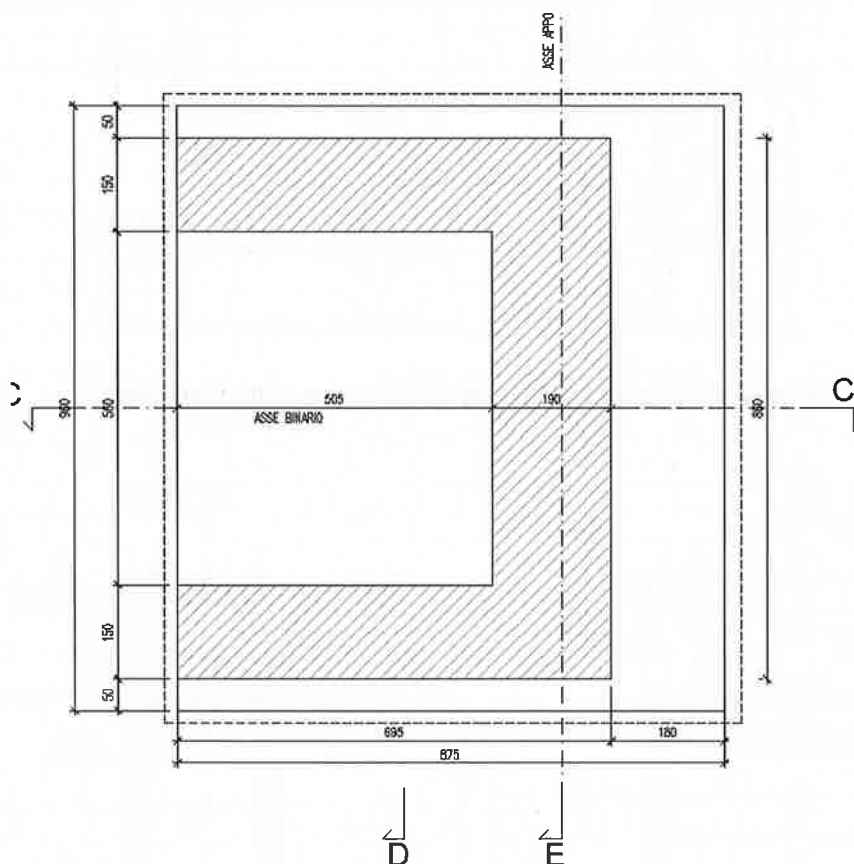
Pianta fondazione spalla A Bonorva VI03
